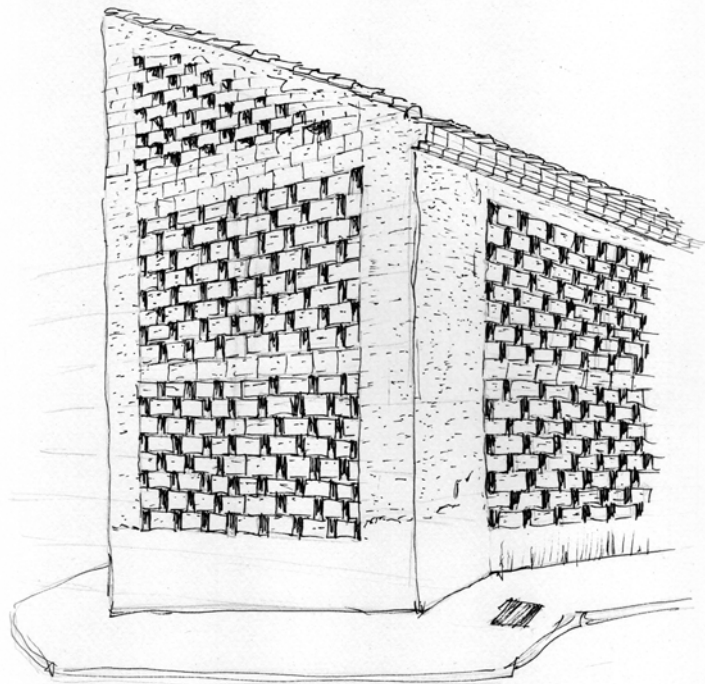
Detalle de secadero de piel de celosía de bloque de hormigón. La proximidad del secadero a un cruce de caminos, hace que su planta no sea rectangular y se adapte a la calzada.
